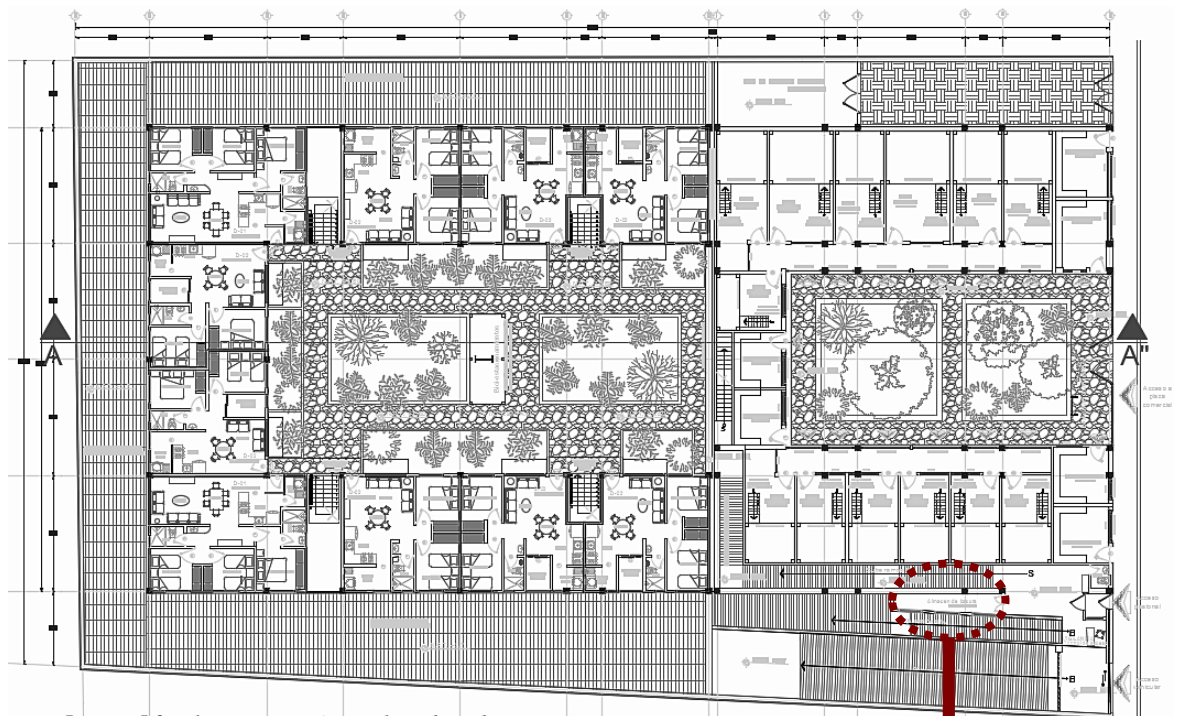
Plano arquitectónico, planta baja de propuesta.
